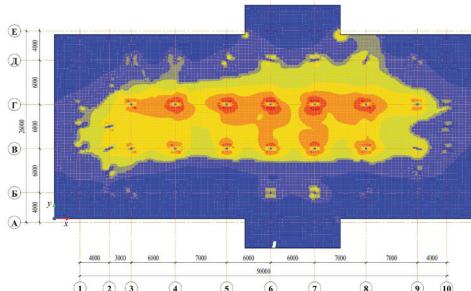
Насыпь ($E = 1,5$ МПа). Карта нижнего армирования фундаментной плиты по оси « Y ». Требуемая площадь рабочей арматуры от 7,46 см²/м (5Ø14) до 59,53 см²/м (5Ø40)
